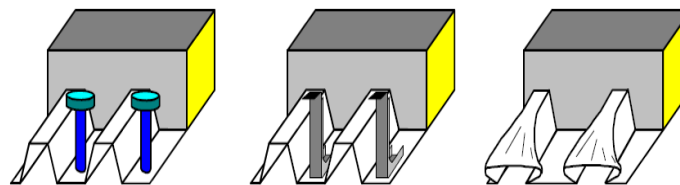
Ancrage d'extrémité dans les dalles mixtes [1]
